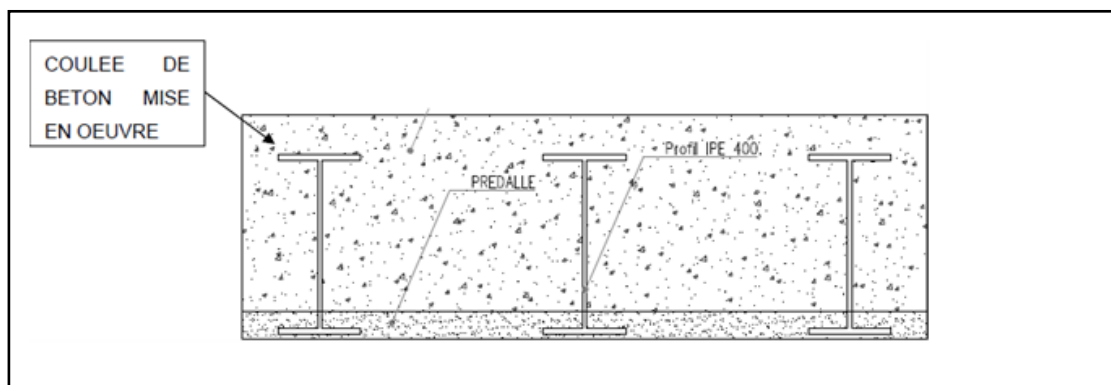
Dalle et prédalle (Détail de la section transversale typique)
